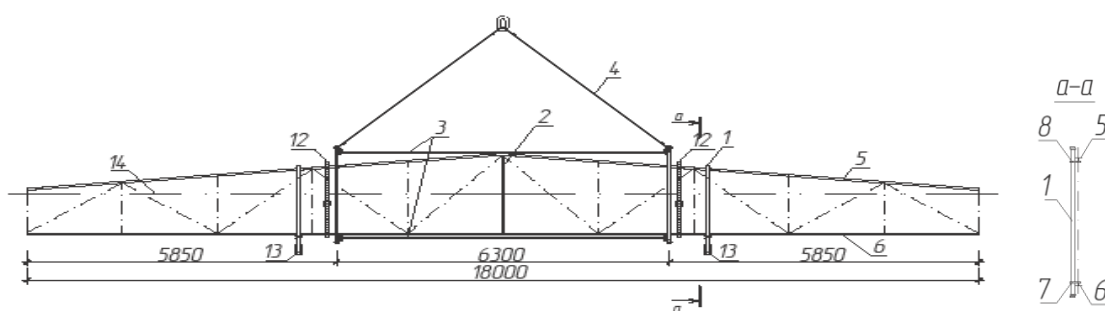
Схема строповки при помощи универсальной траверсы
